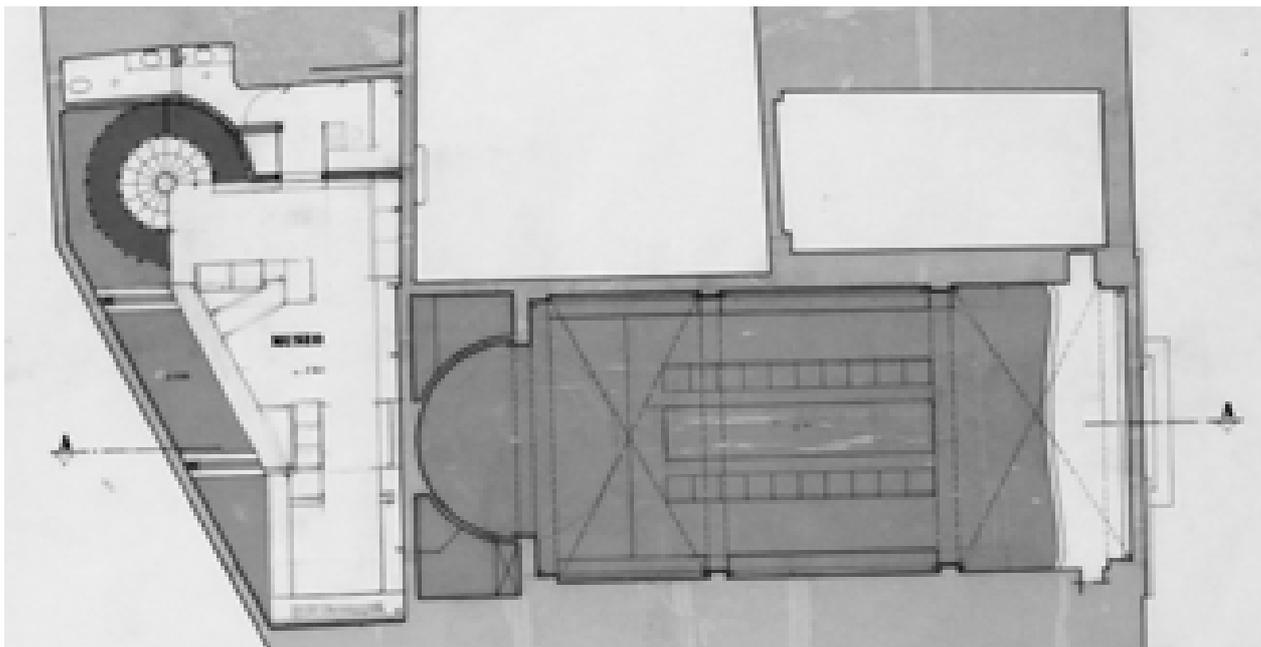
Pianta quota +2,80– Stato di progetto – 10/11/1980 (AABS-94.167)
